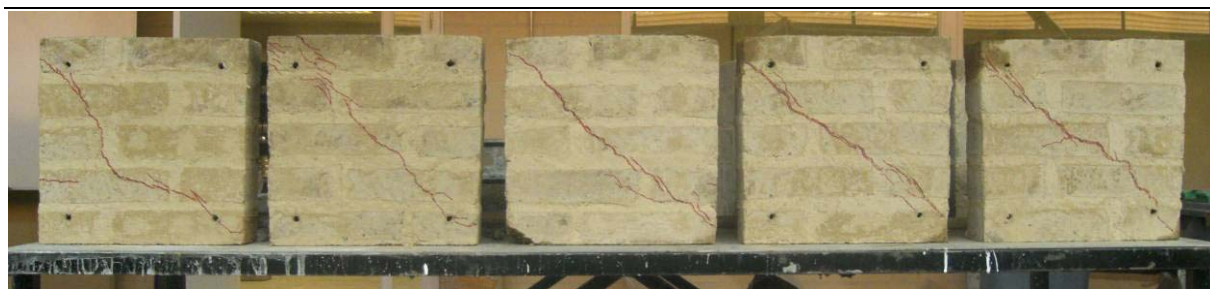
Prismas ao final de ensaios de compressão diagonal. As linhas de fissuras foram ressaltadas com tinta vermelha diretamente nos prismas.
